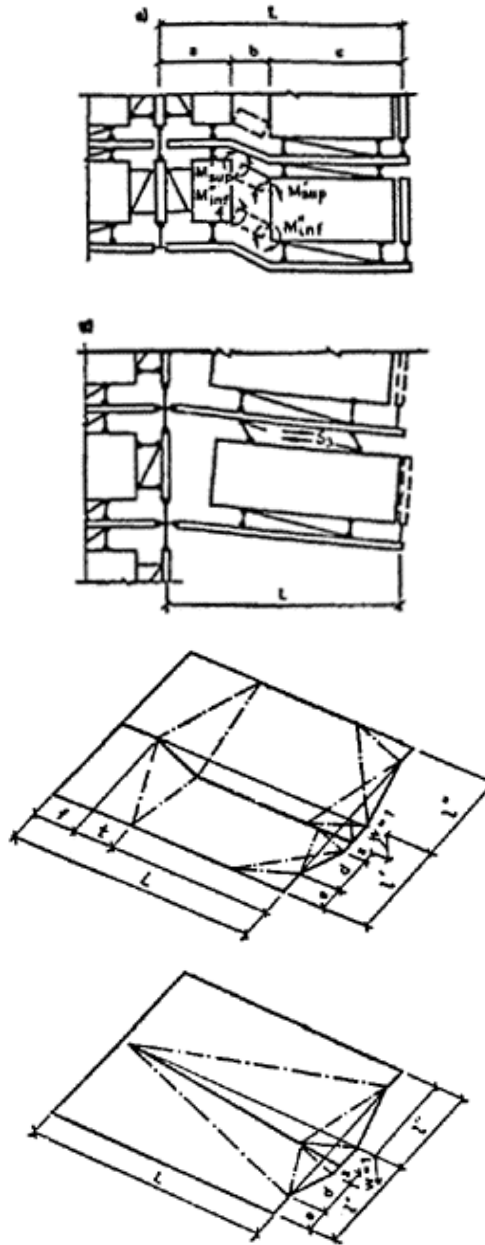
Работа плит перекрытий в зданиях с железобетонными наружными стенами
